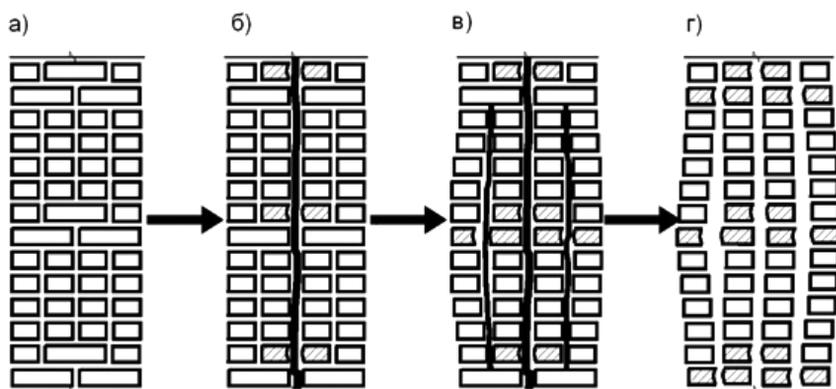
Этапы разрушения кирпичной кладки возведённой по американской системе перевязки швов : б) первая стадия разрушения наружной стены; в) вторая стадия разрушения стены; г) предаварийное состояние стены.
